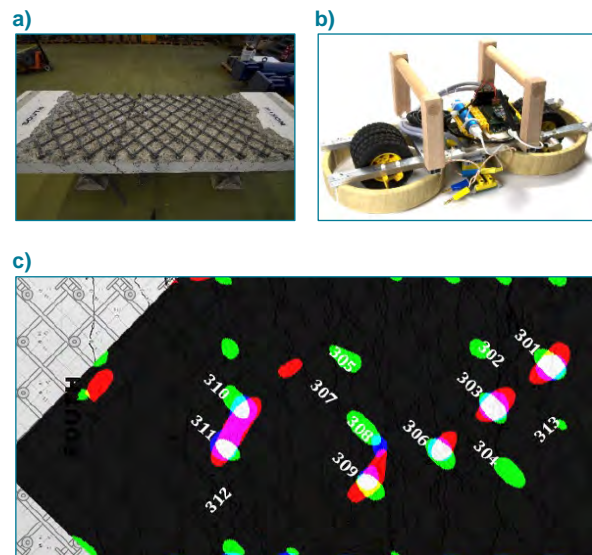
Ermüdungsversuche an Stahlbetonplatten; a) Platte nach dem Versuch mit freigelegter Bewehrung, b) Messwagen mit Magnetspulen, c) Detektierte Ermüdungsbrüche
